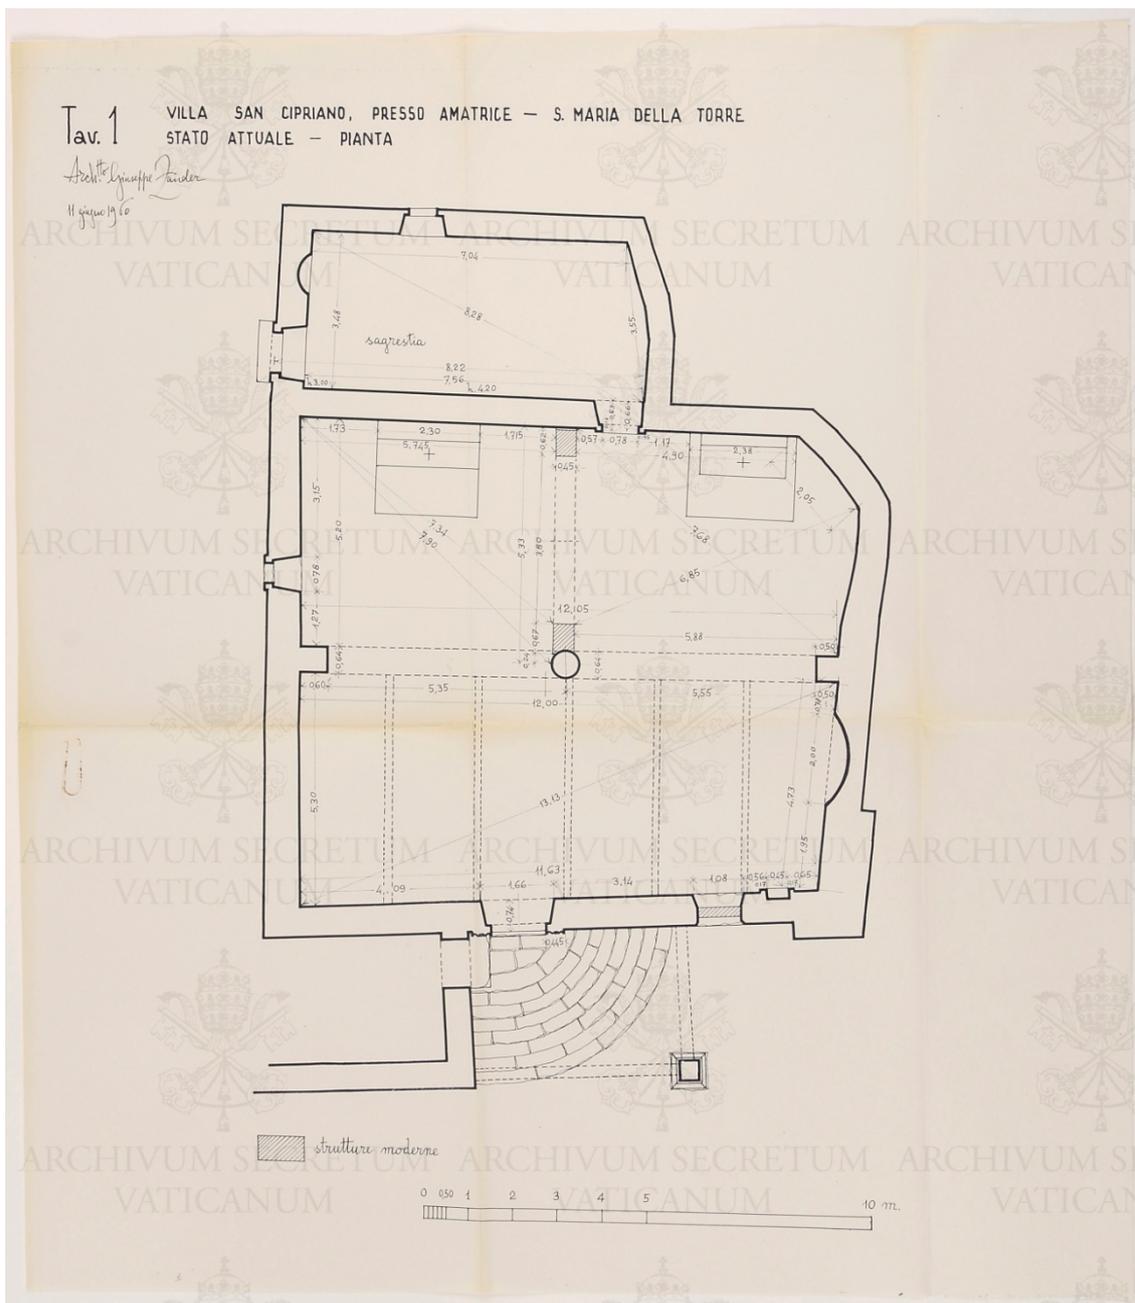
11 giugno 1960 - Elaborati di progetto di Giuseppe Zander - Tav. 1, rilievo architettonico dello stato attuale, pianta (ASV)
